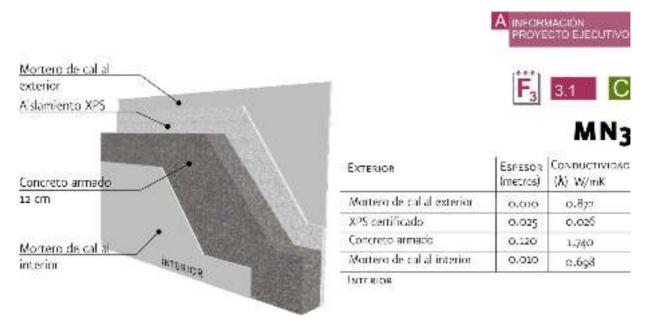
Composición de muro MN3 de acuerdo a proyecto arquitectónico.
